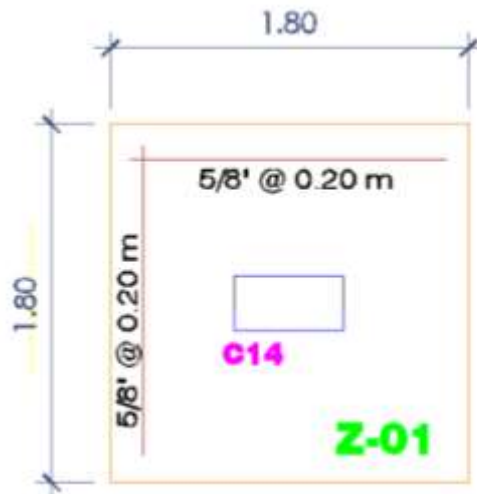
Distribución de acero en planta para la zapata de la Columna COL 10
